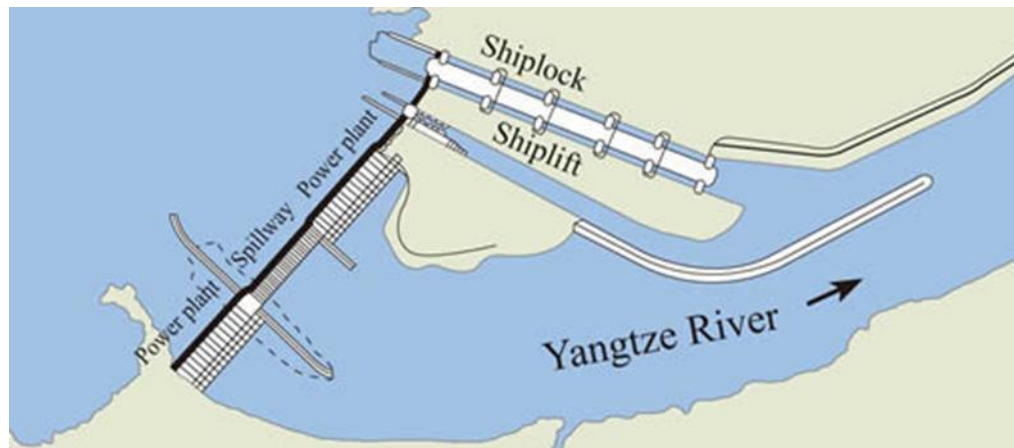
Planta geral da barragem Three Gorges (China, 2004) [77]
